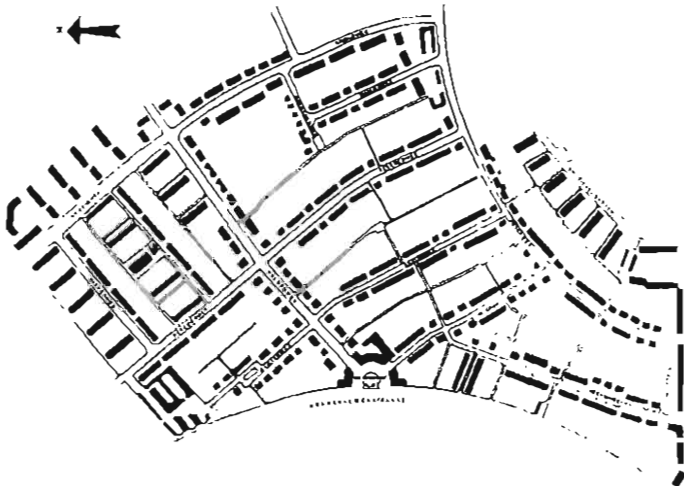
Lageplan der Gartenstadt Karlsruhe mit Stand der Bebauung im Jahr 1982
